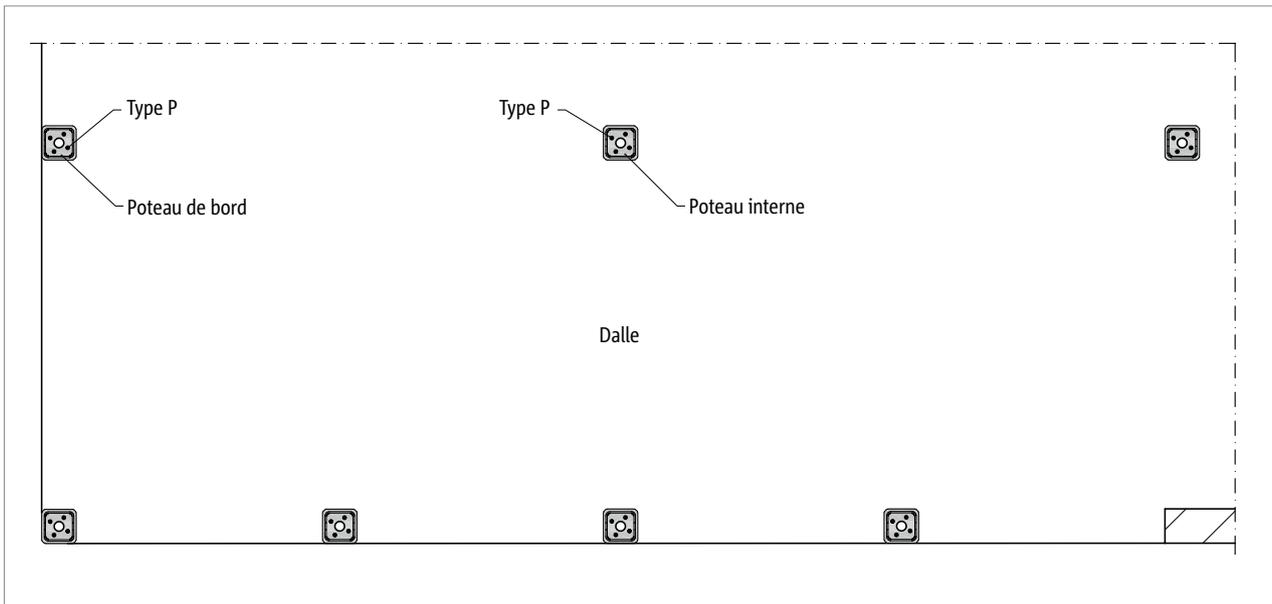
Schöck Sconnex® type P : disposition des éléments en plan
